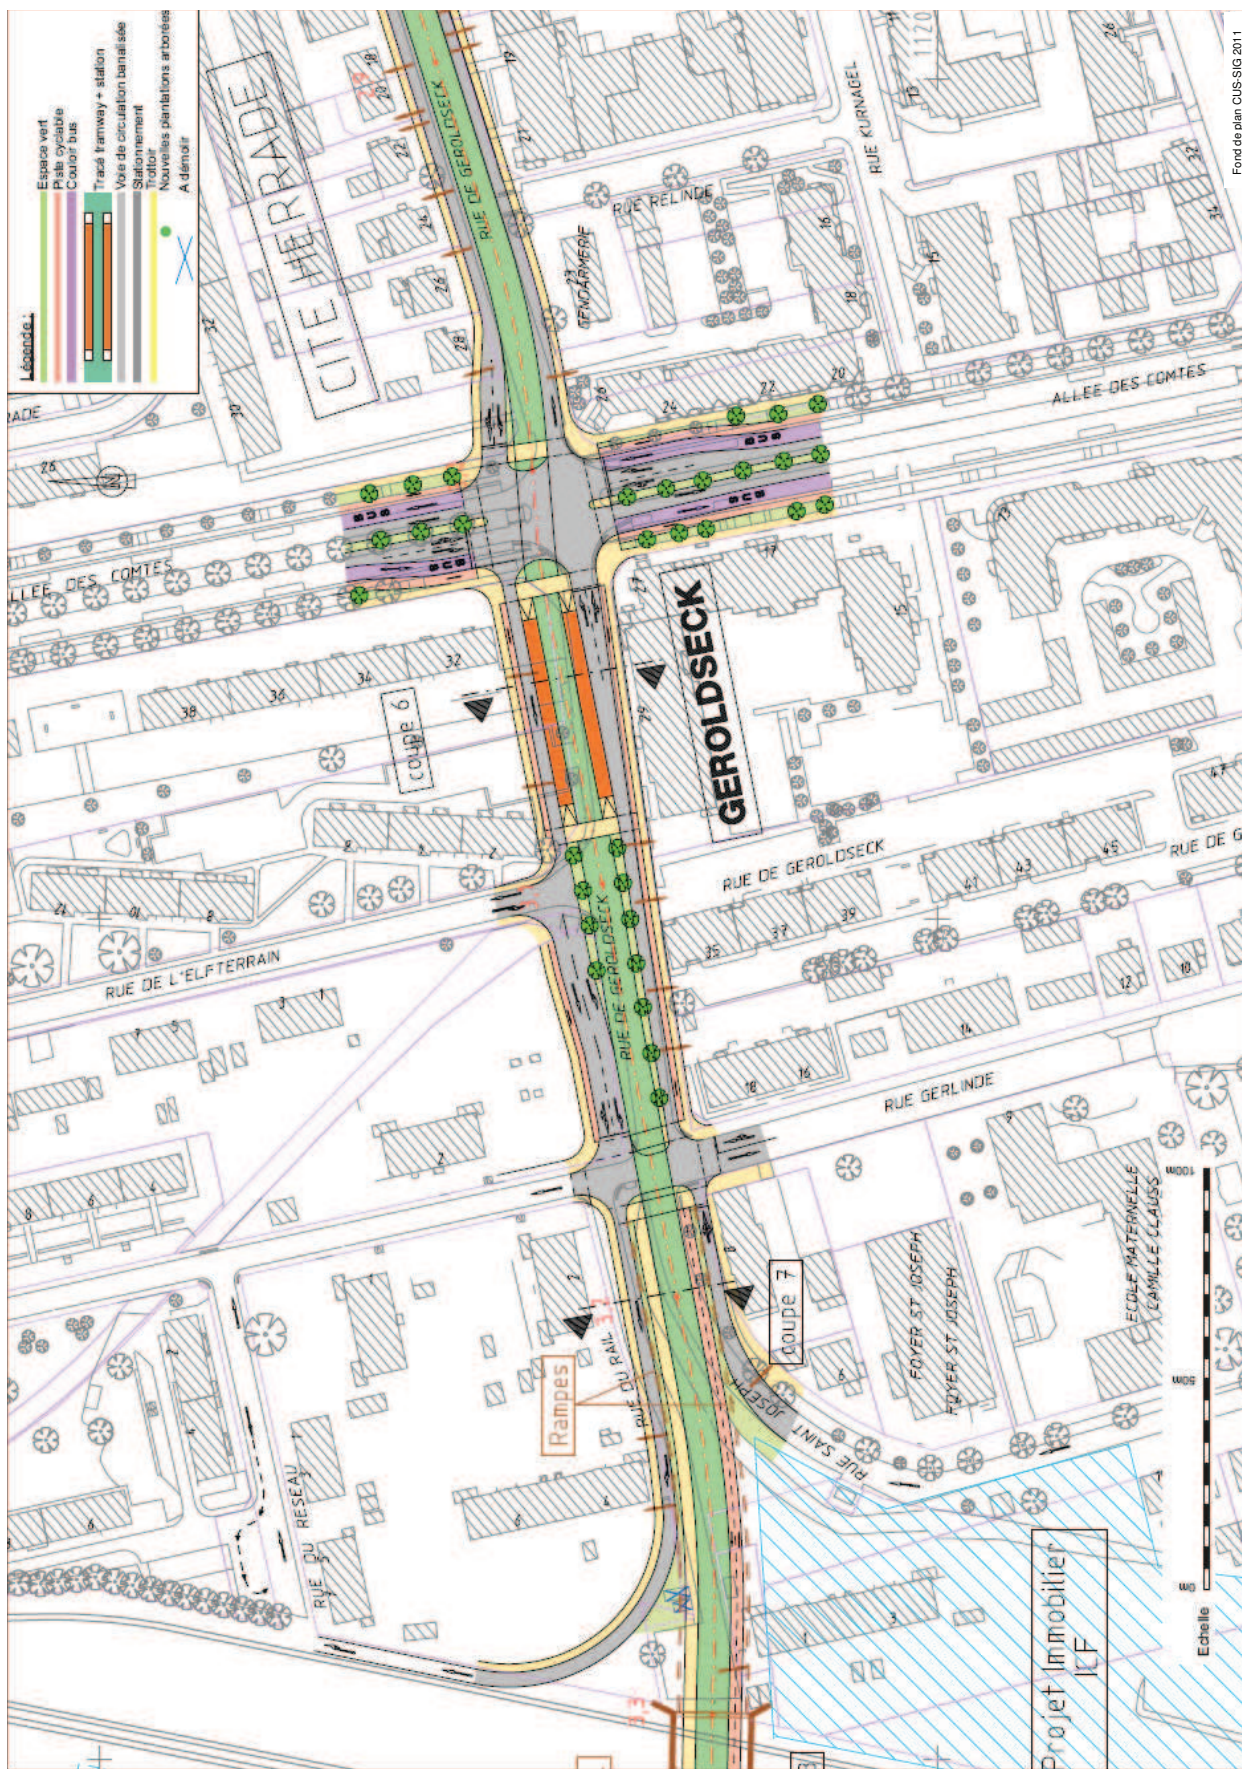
Plan zoom sur secteur "Geroldseck / Comtes"
